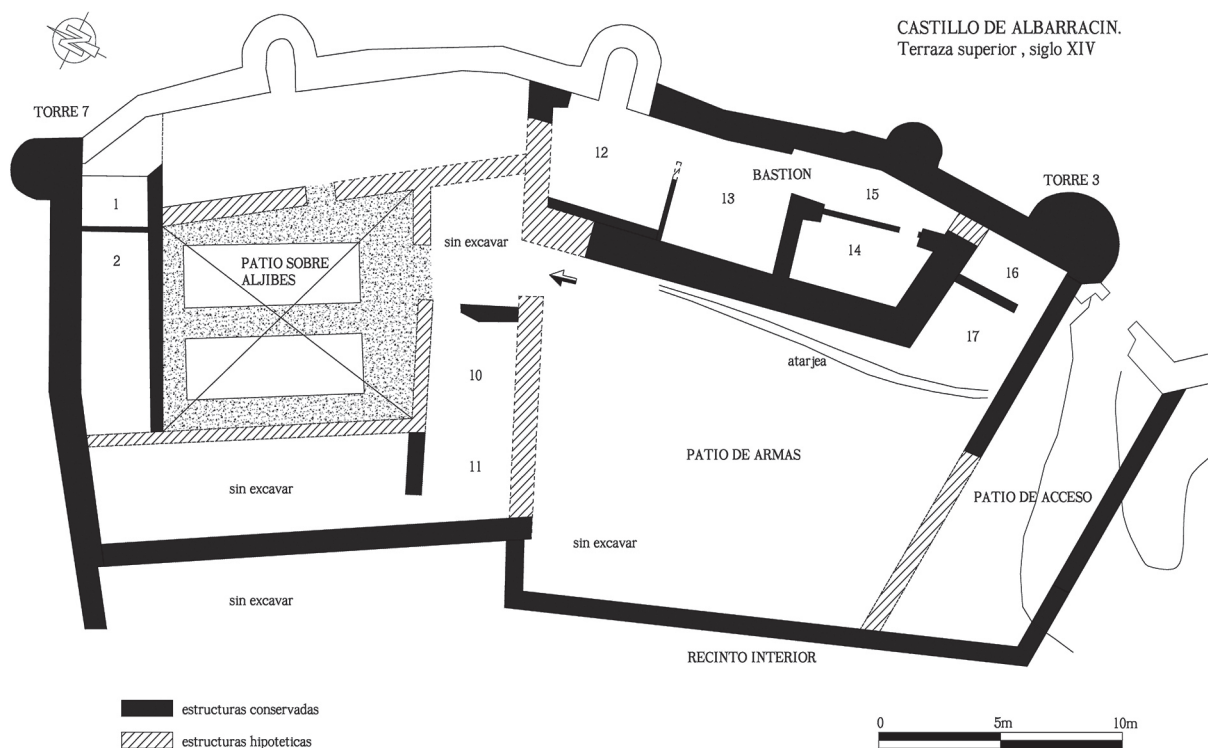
Planta con las estructuras documentadas en la zona alta, período 5.
